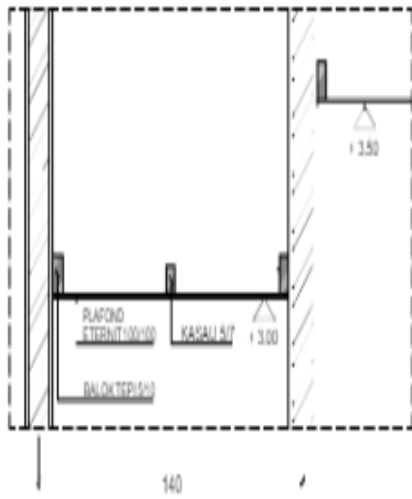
1 BH	SKALA 1 : 25	DETAIL P2	2 BH	SKALA 1 : 25
